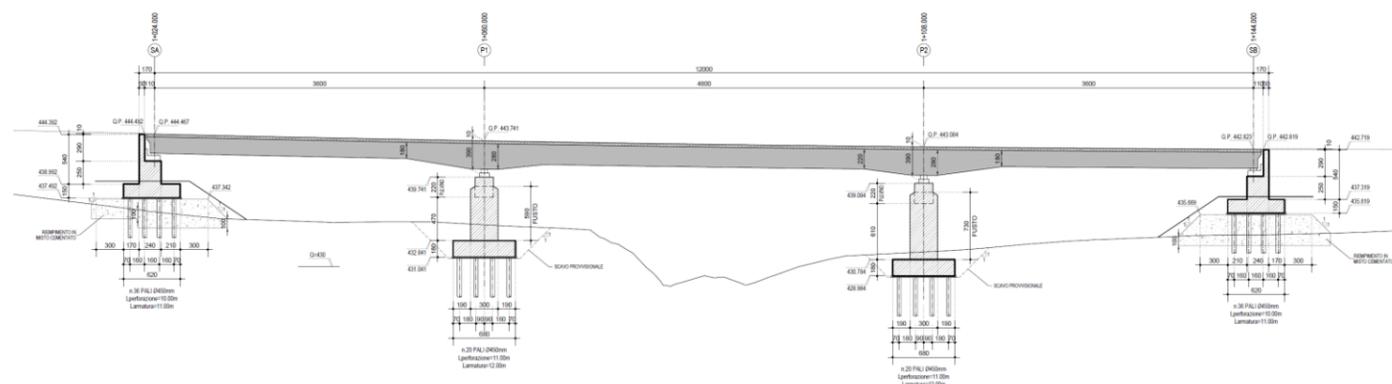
Sezione longitudinale lungo asse tracciamento
